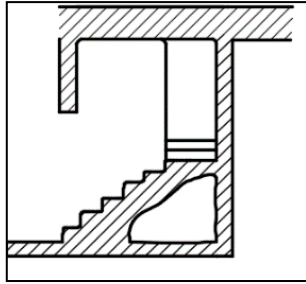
coupe de l'escalier. Source: fait par l'auteur
